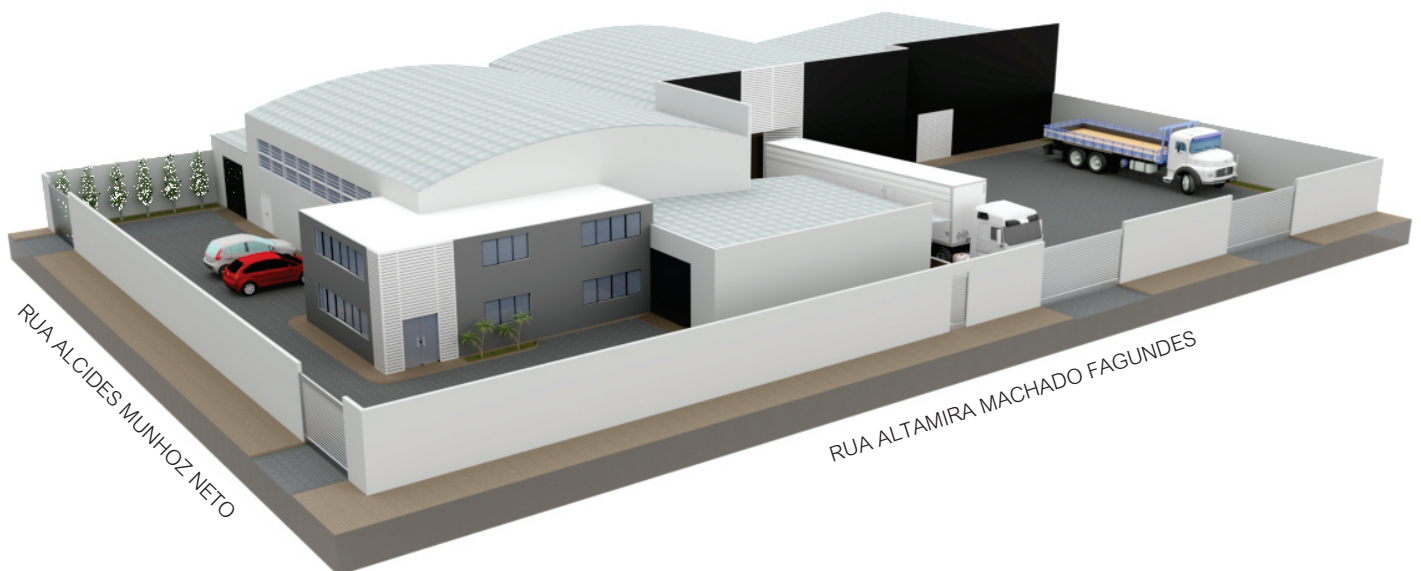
IMAGEM: PROPOSTA DE PROJETO PARA BARRACÃO.
